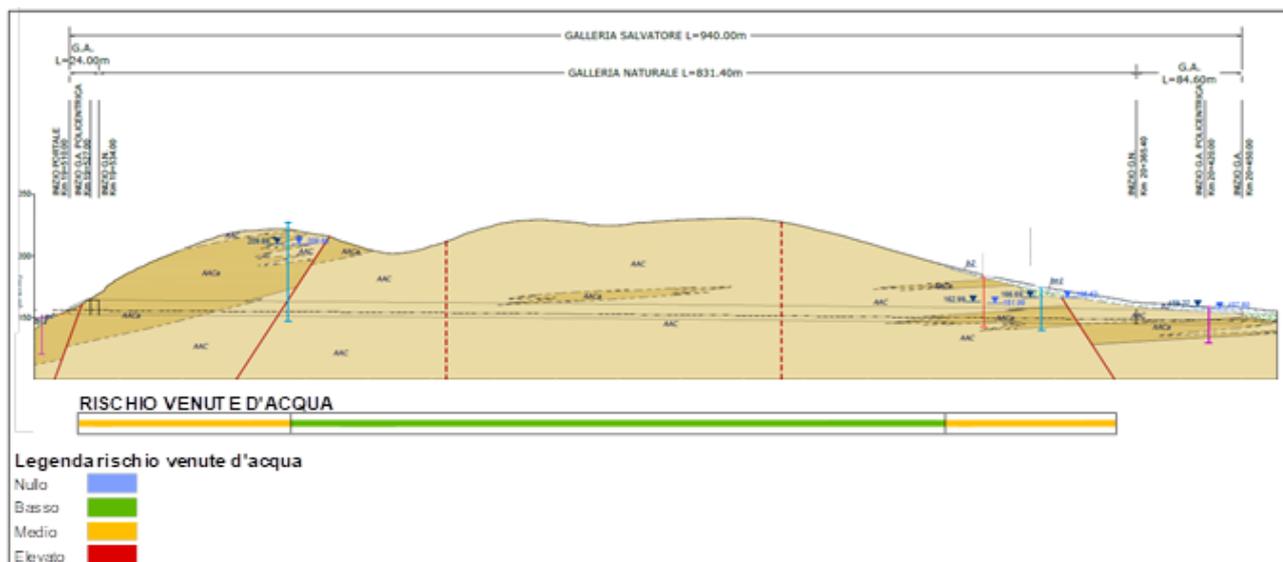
Galleria Salvatore: Stralcio profilo geotecnico
